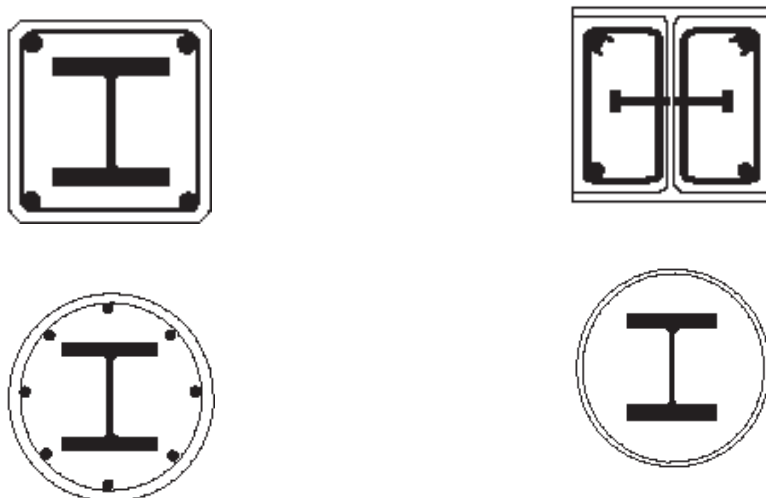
Exemples de sections transversales des poteaux mixtes [2].
